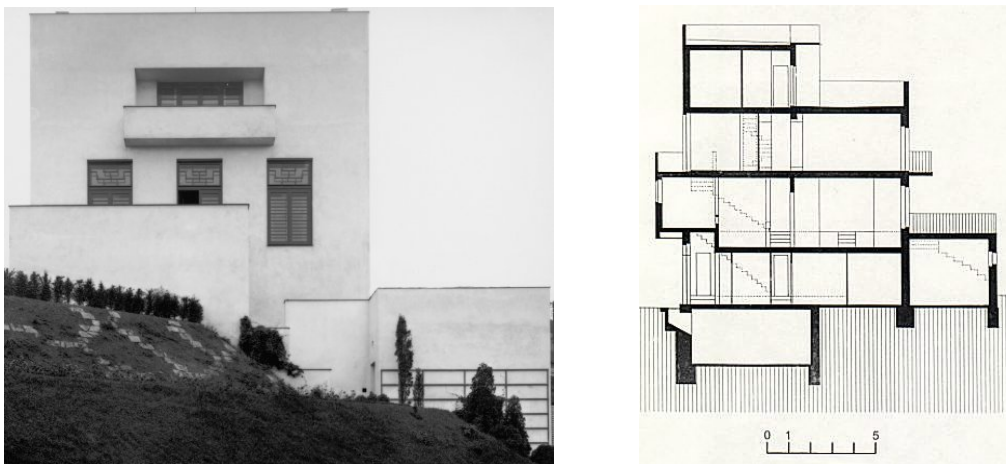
A. Loos, Casa Müller, vista del prospetto principale e sezione trasversale
